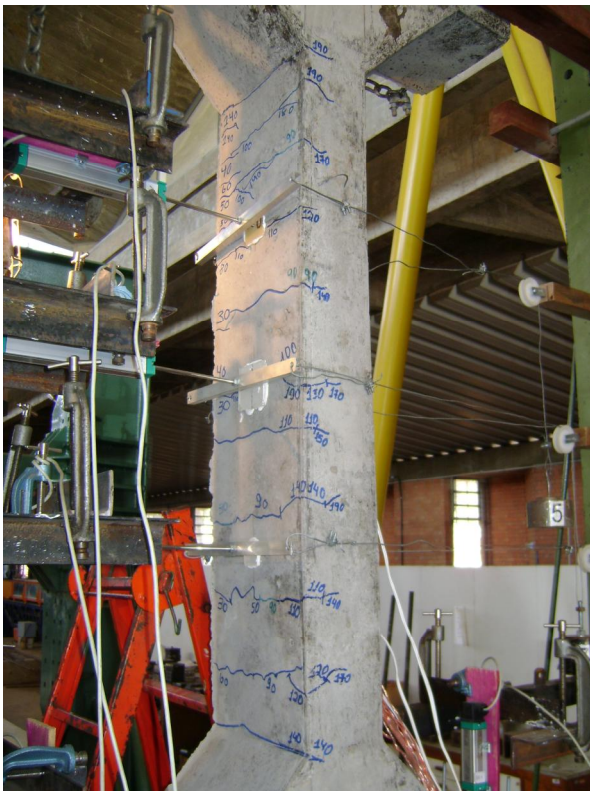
Fissuras do pilar PFN 50-2
